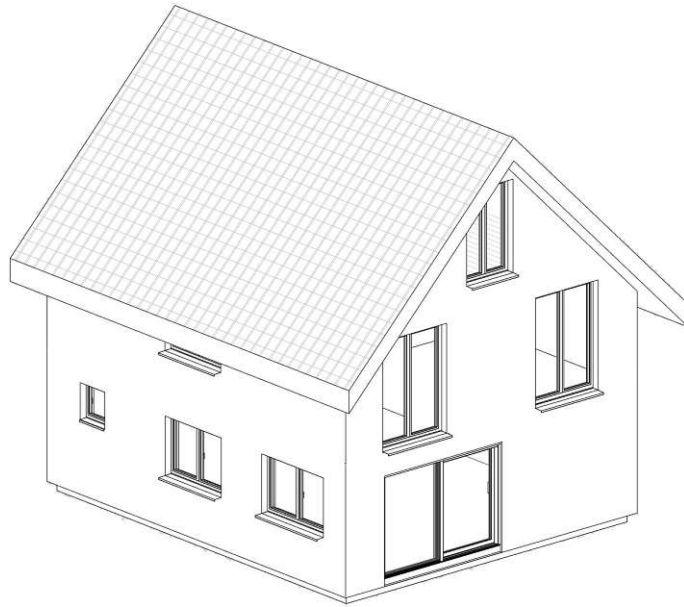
Fertiges BIM Modell mit dem Workflow „04 - Revit - NUBIGON“
